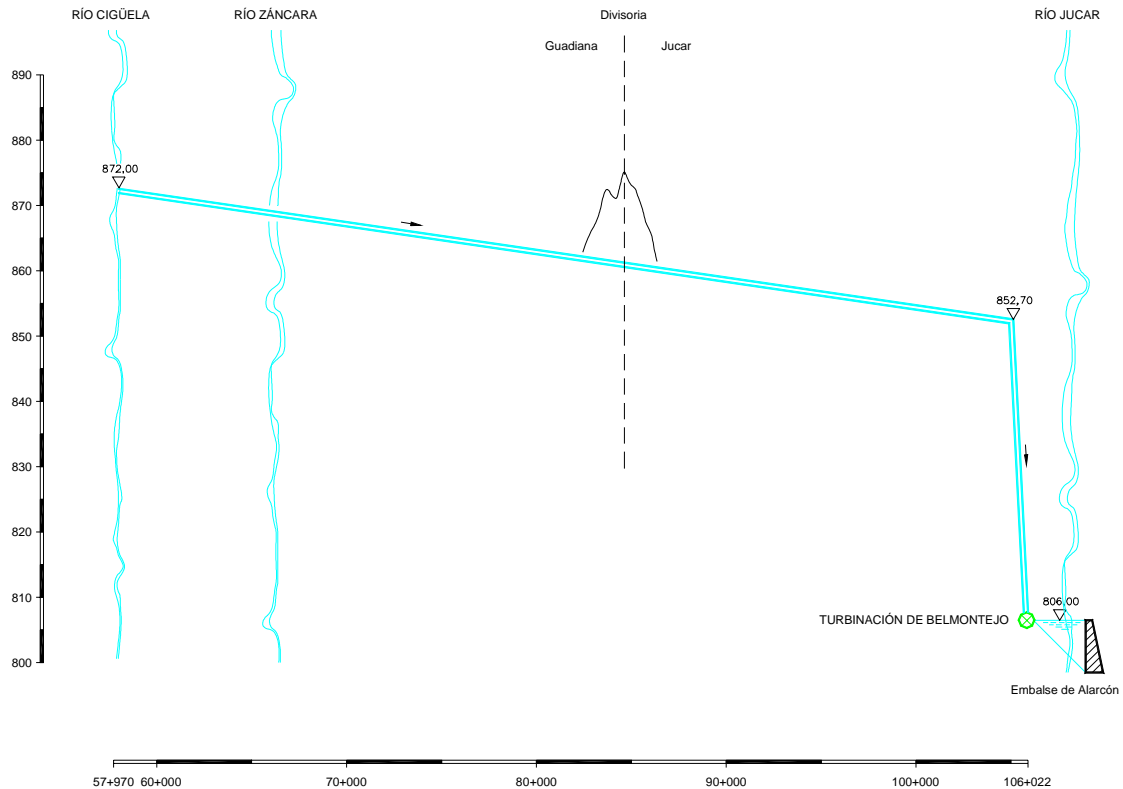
Conducción Cigüela - Alarcón. Esquema en alzado
